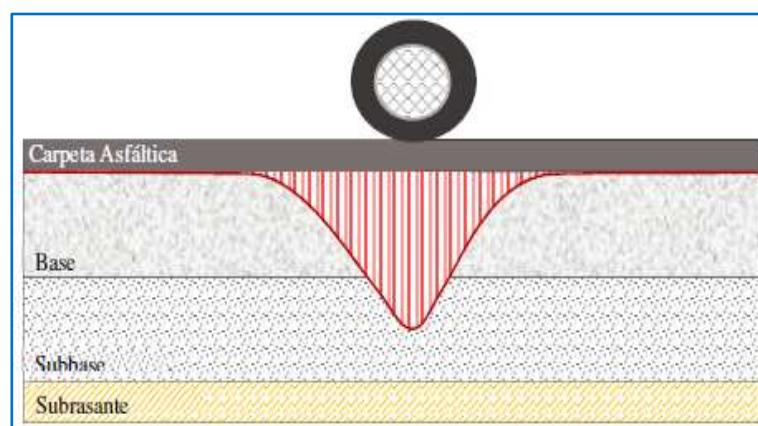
Estructura y distribución de cargas en pavimento flexible
